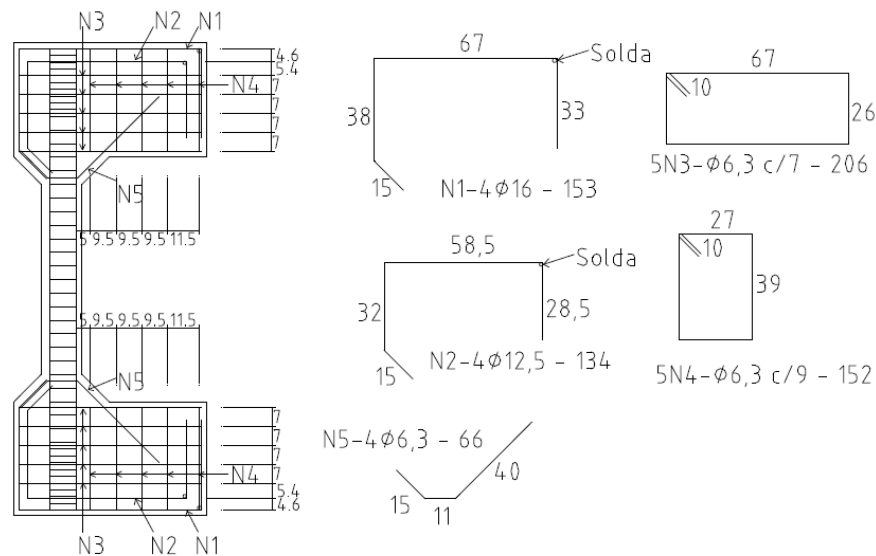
Detalhamento da armadura do consolo – VANDERLEI (1999)
